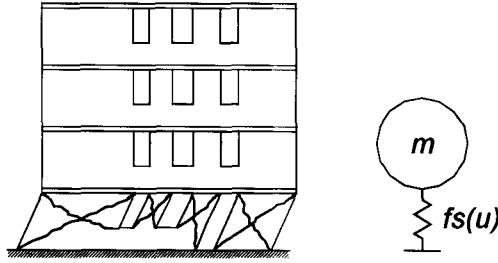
Modelado de un edificio con daño solo en planta baja [7]
